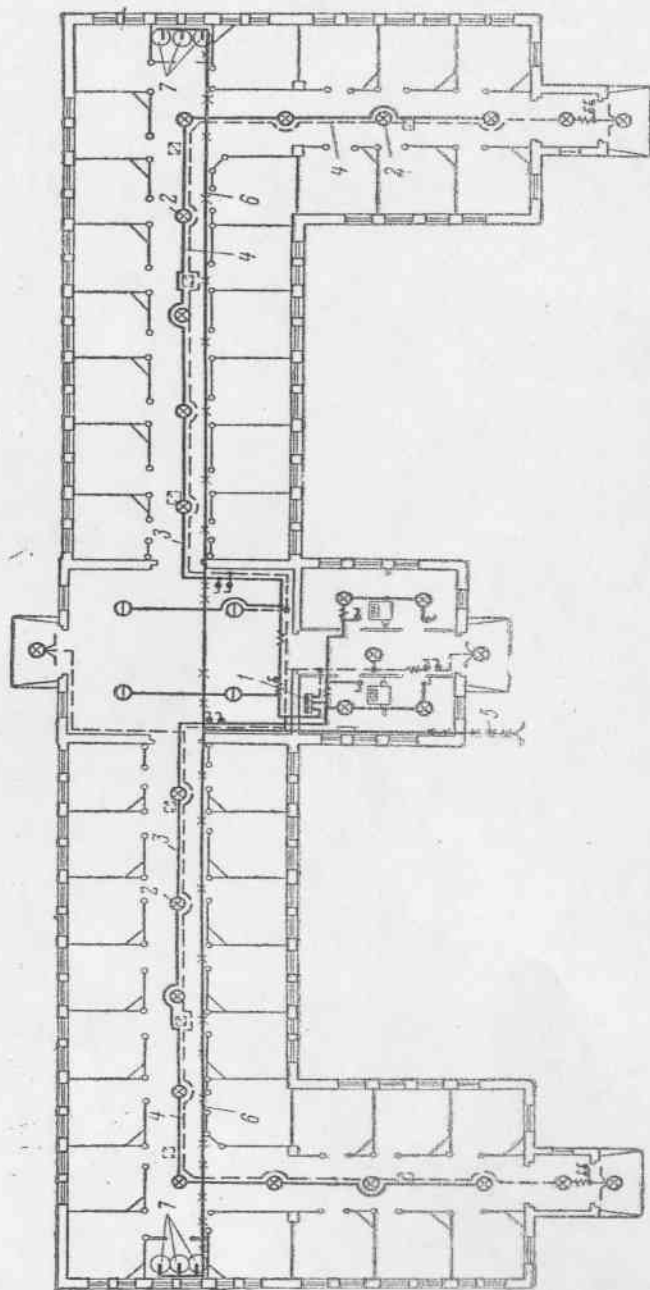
План конюшни на 40 племенных лошадей со схемой сетей электроосвещения и водопровода: 1—групповой щиток; 2—арматура фарфоровая полугерметическая; 3—сеть рабочего освещения; 4—сеть дежурного освещения; 5—ввод от наружного водопровода; 6—бочки для воды.
